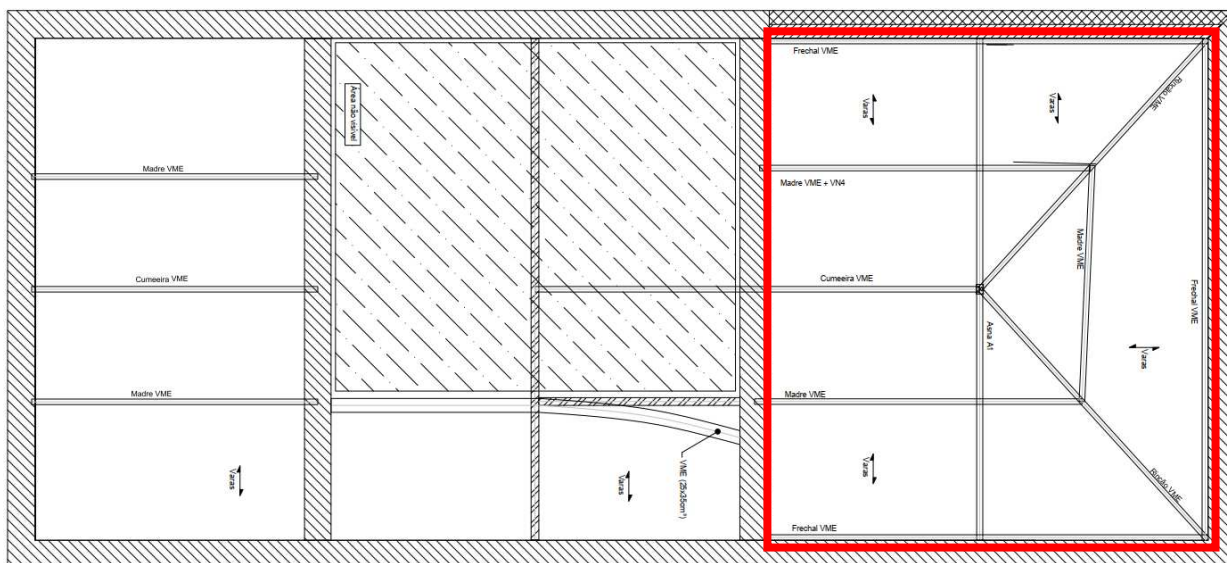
Levantamento estrutural dos elementos estruturais cobertura
